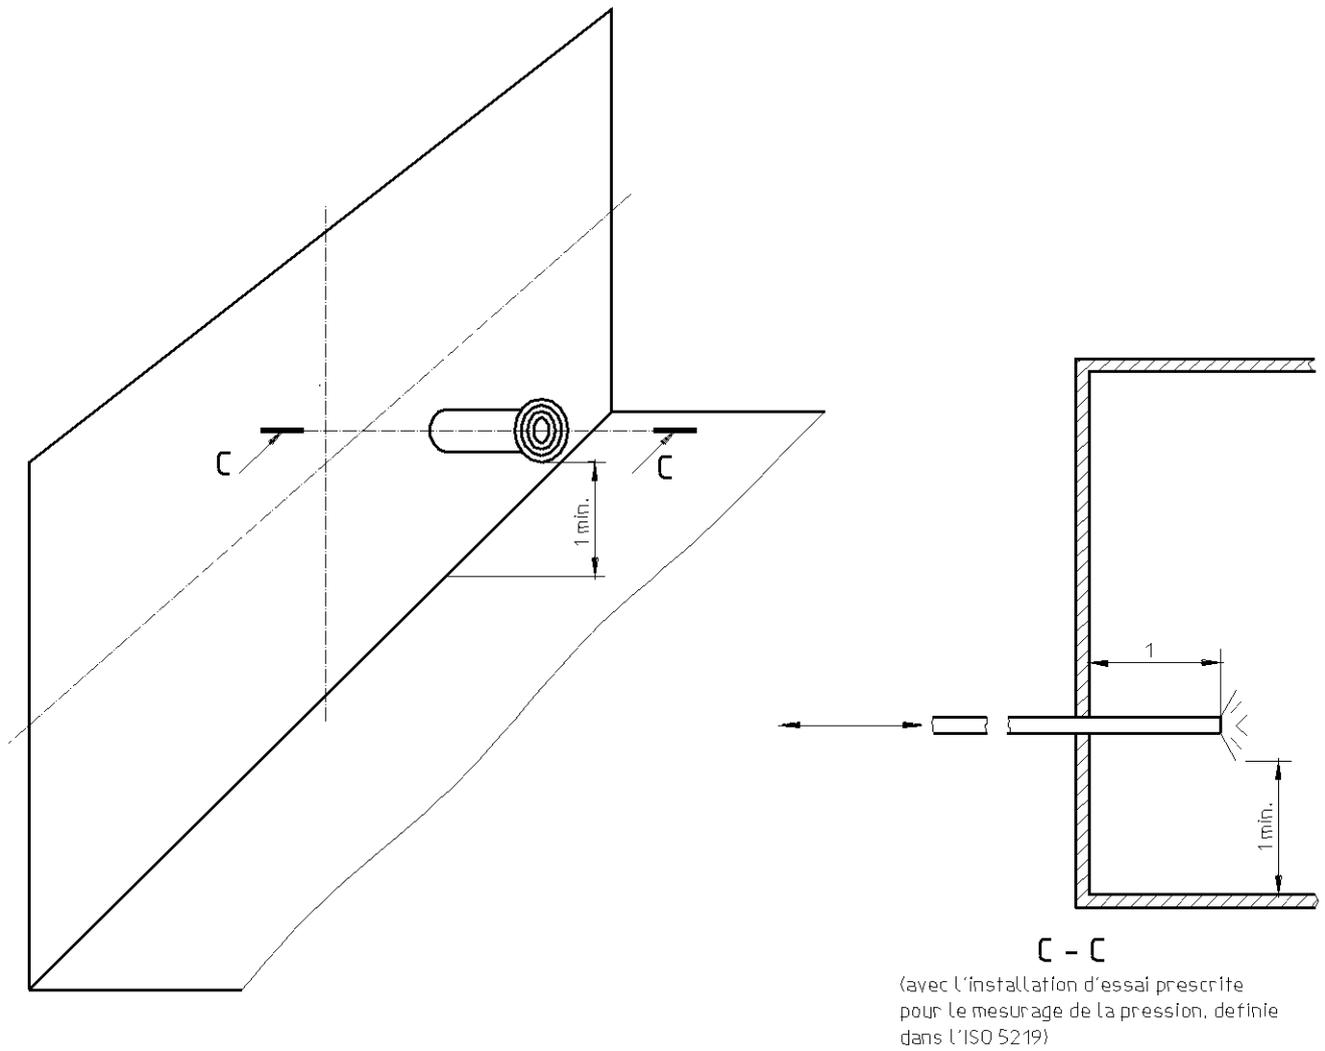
Détail du montage d'un équipement installé à l'intersection de deux surfaces
